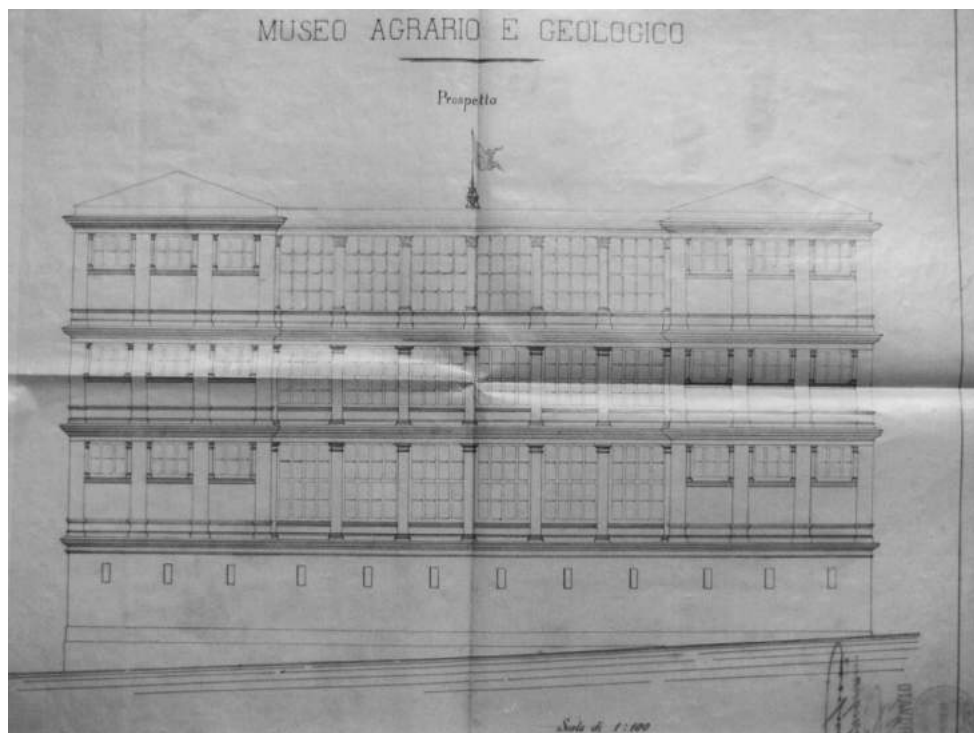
PROSPETTO SU VIA DI SANTA SUSANNA DEL PROGETTO DI RAFFAELE CANEVARI CON L'AGGIUNTA DELLA GALLERIA DEL TERZO PIANO (ASC, TITOLO 54, PROTOCOLLO 1797 (2) ANNO 1889). SI CONFRONTI CON LA PIANTA DEL MEDESIMO PROGETTO FIG. 26.
